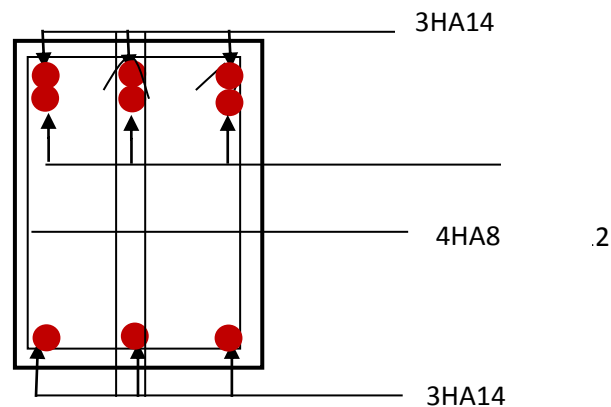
Ferraillage sur appuis d'une poutre principale
